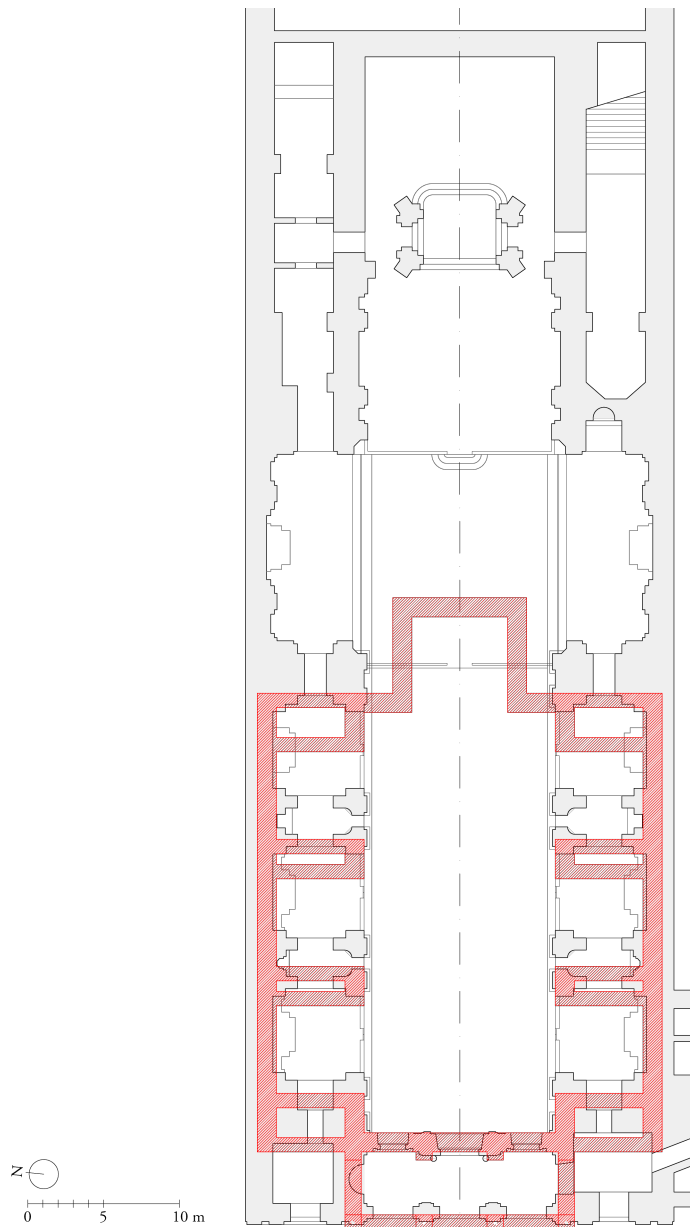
Sobreposição da planta da igreja de São Vicente de Fora, Lisboa, com planta gerada pela GF<sub>AE</sub> (a vermelho).
